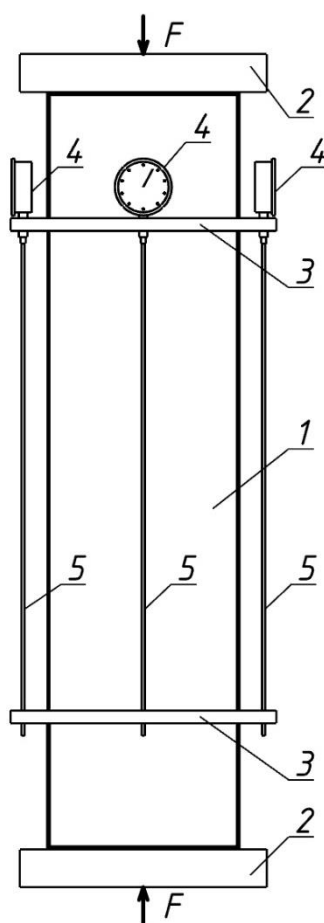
Схема испытания бетонной призмы на сжатие:
